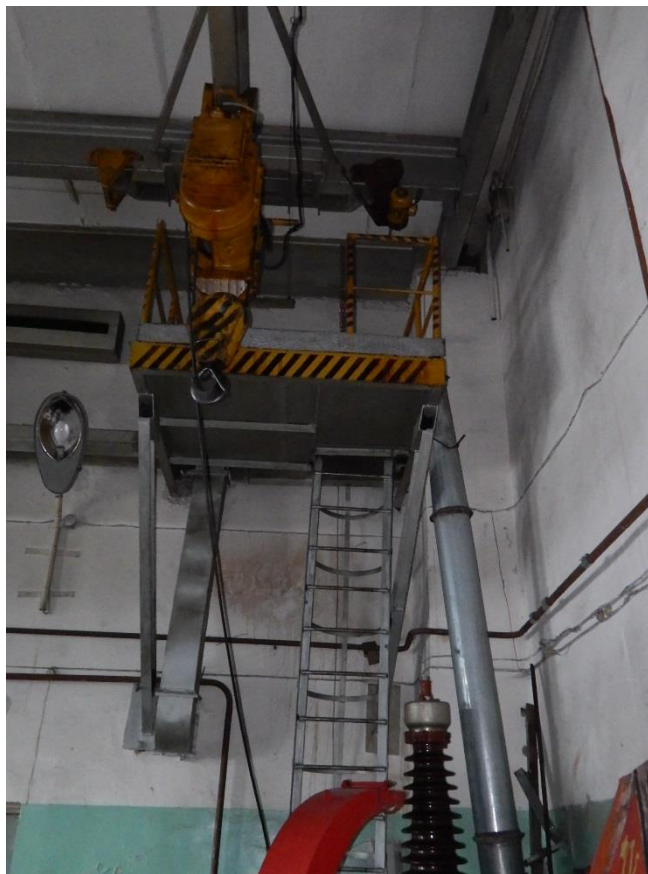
Внешний вид площадки обслуживания кран-балки по стене, расположенной по оси 3
